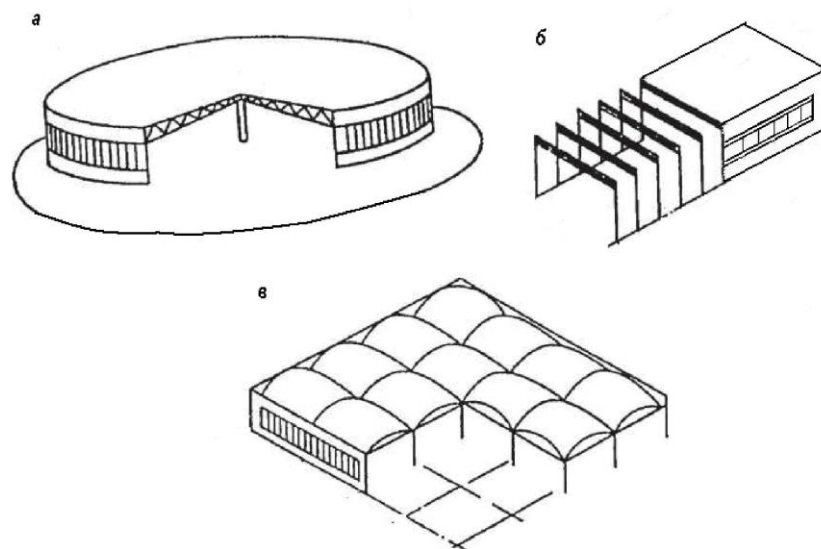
Одноповерхові виробничі будівлі [1]: *a* – зального типу з центральною опорою; *б* – зального типу без проміжних опор; *в* – коміркові
